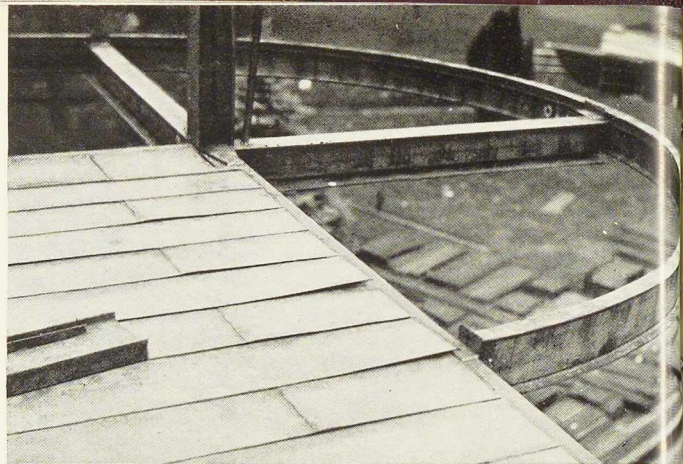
Une poutre d'extrémité de balcon. On note au premier plan les planchers en tôle.
